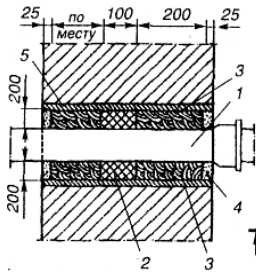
Пересечение трубы ввода со стеной подвала здания в сухих грунтах:
